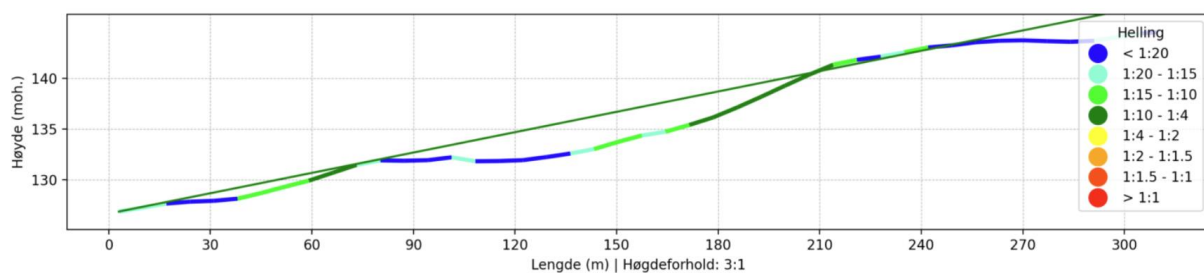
Snitt A, starten av planområdet er vist med et svart kryss
